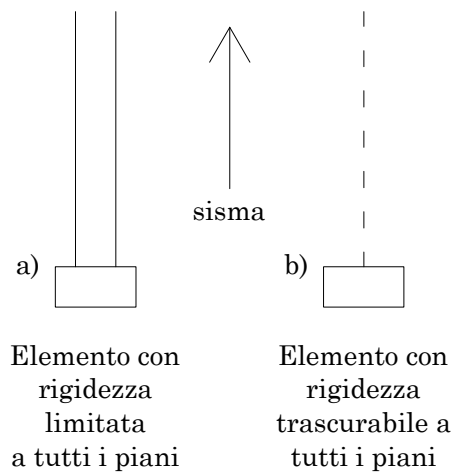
Contributo dei pilastri con inerzia minima alla rigidezza della struttura.
